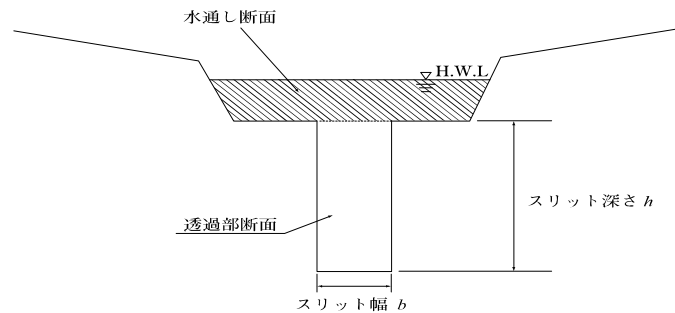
コンクリートスリット砂防堰堤の水通し断面と透過部断面
